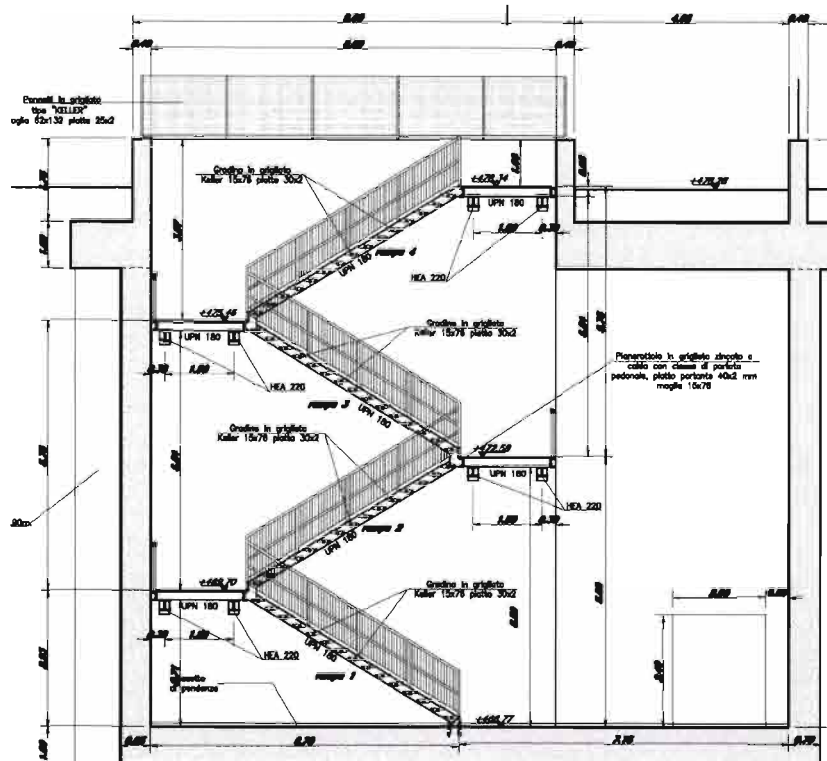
Sezione scala Interconnessione Ponte Gardena
